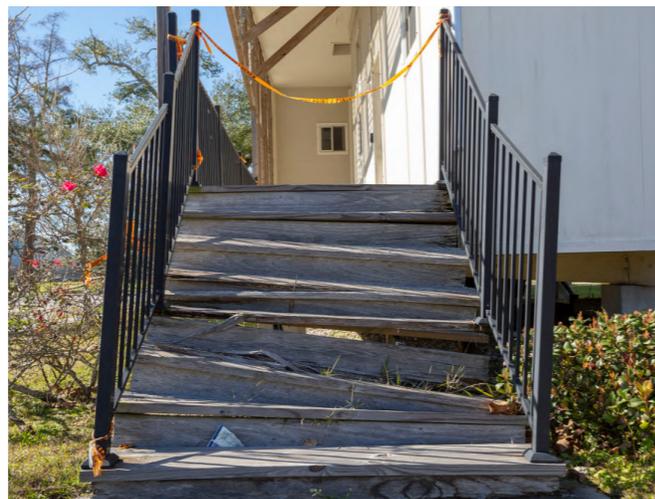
Fotografia dei problemi riscontrati dopo pochi anni dalla costruzione di uno degli edifici costruiti dalla fondazione. Fonte: www.nypost.com da MEGA casa di Mary Picout
